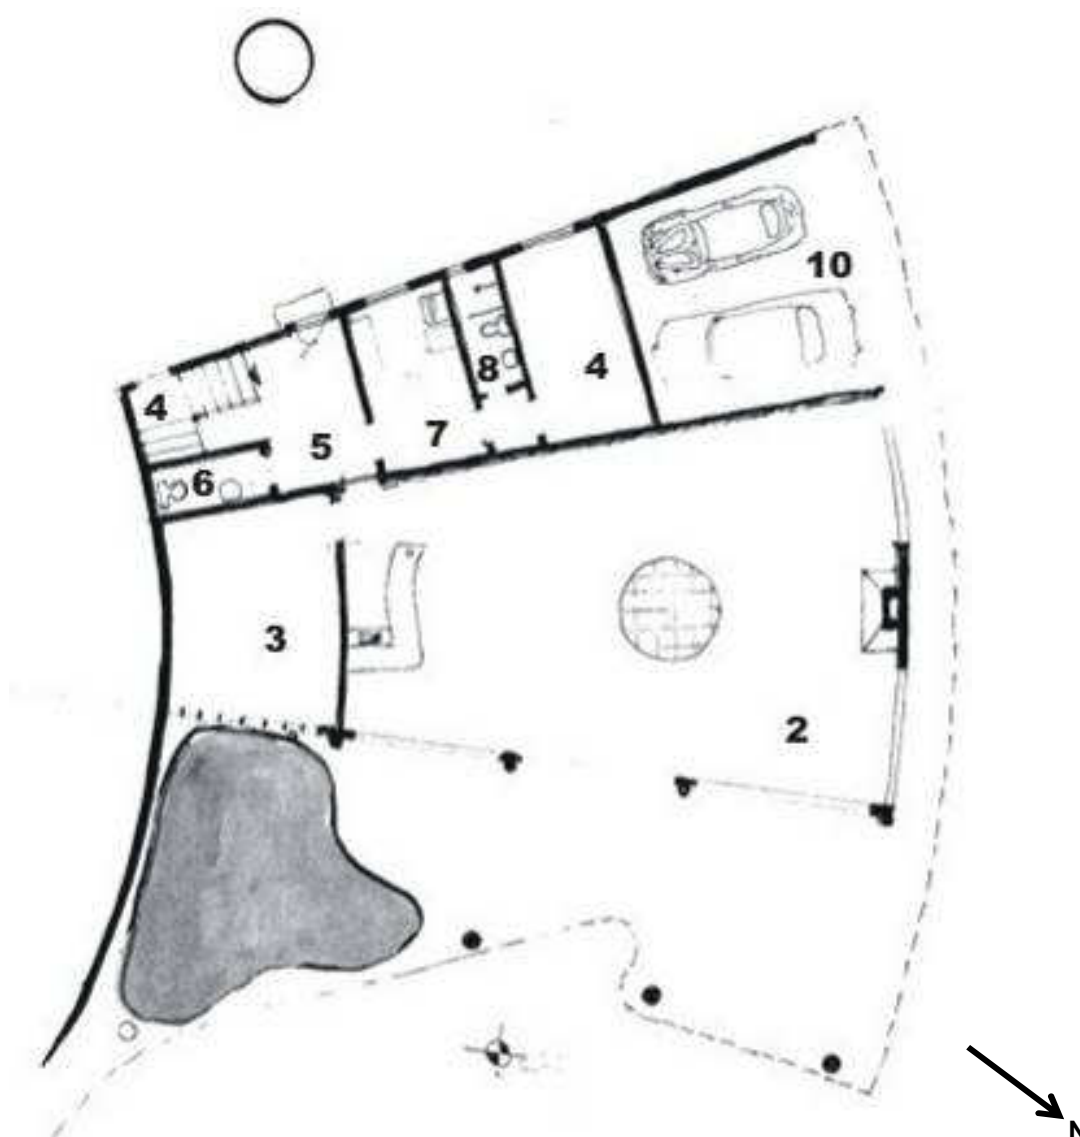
PLANTA PAVIMENTO TÉRREO
